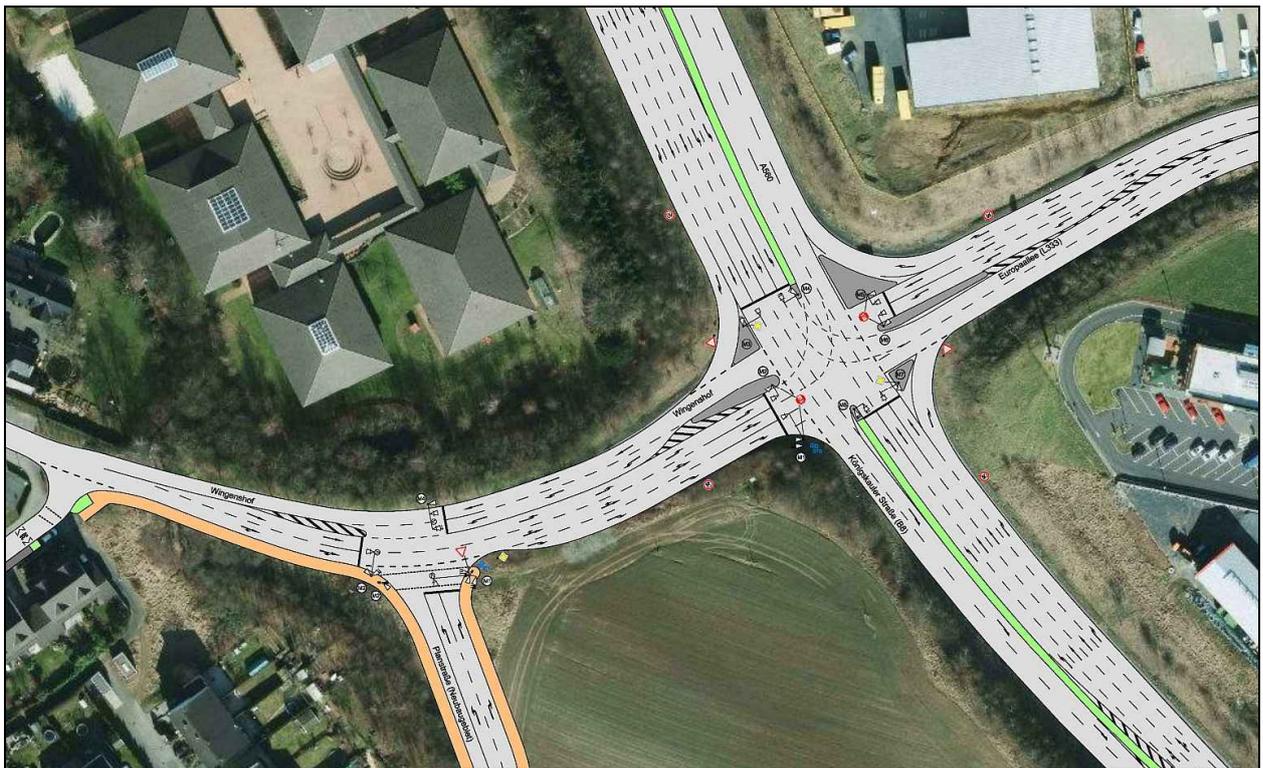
Lageplan der Vorzugsvariante mit Darstellung der Signalanlagen (vgl. Anlage E-1)
